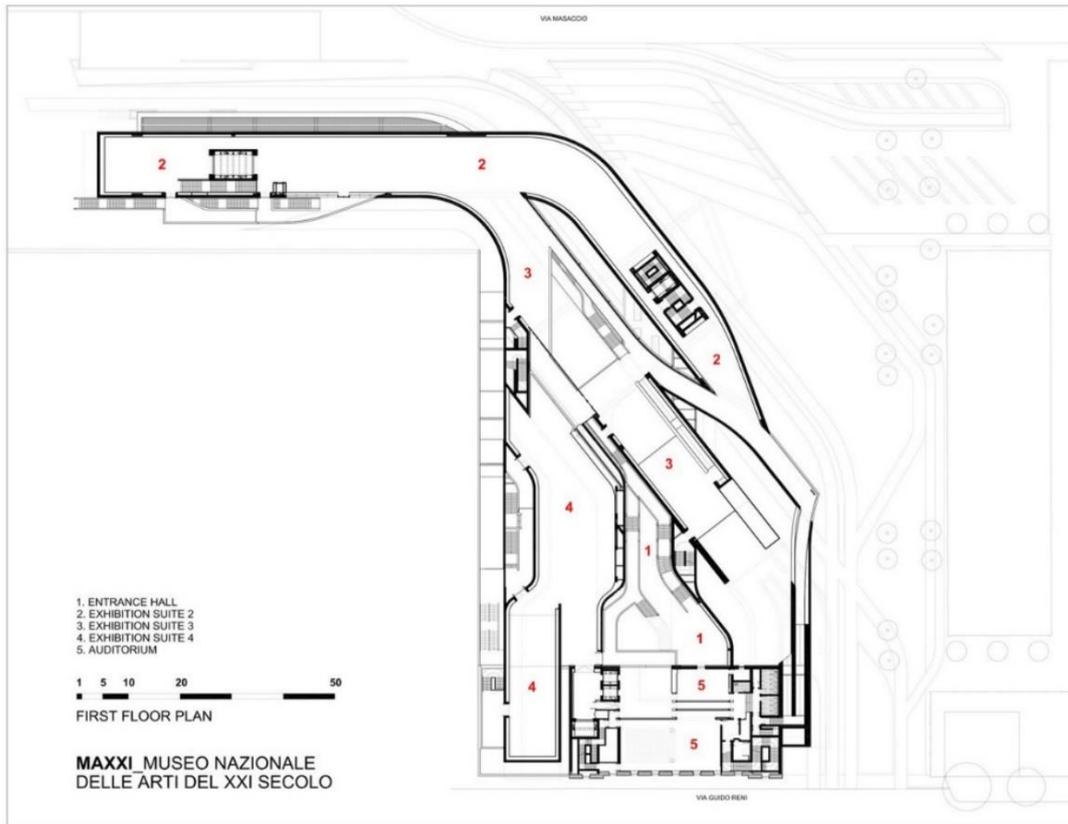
Pianta primo piano (<https://www.zaha-hadid.com/>)
